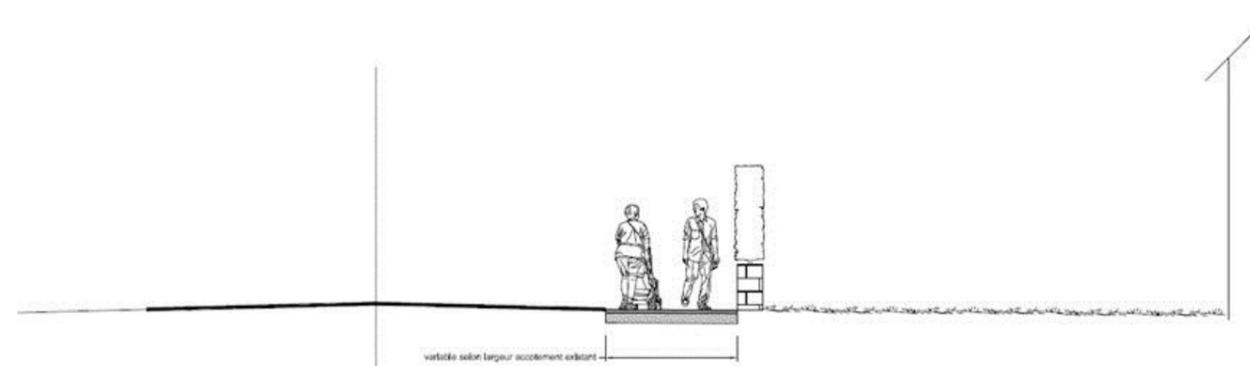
Le profil en travers d'un aménagement en site propre en mitoyenneté d'une route
